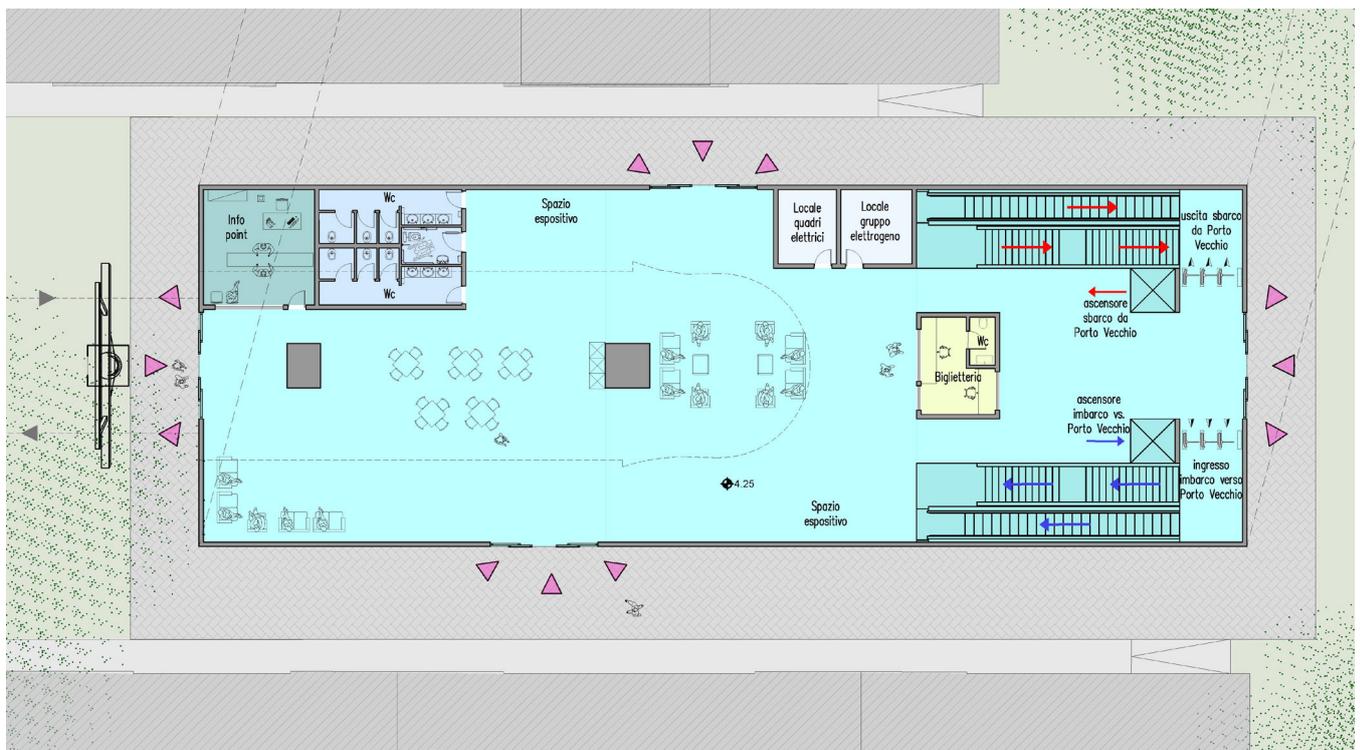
Planimetria piano terra stazione terminale di "Trieste" con distribuzione locali.
